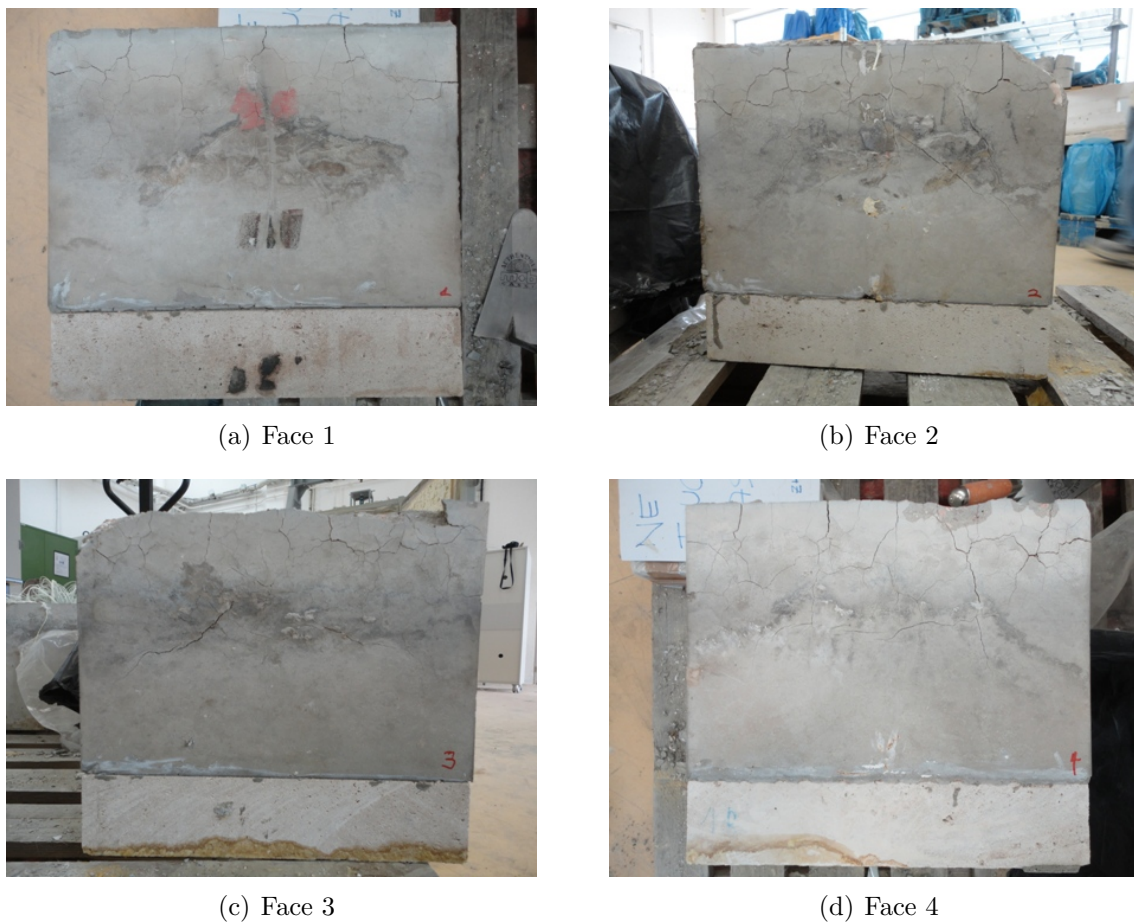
Faces do concreto CAD-600 após aquecimento
